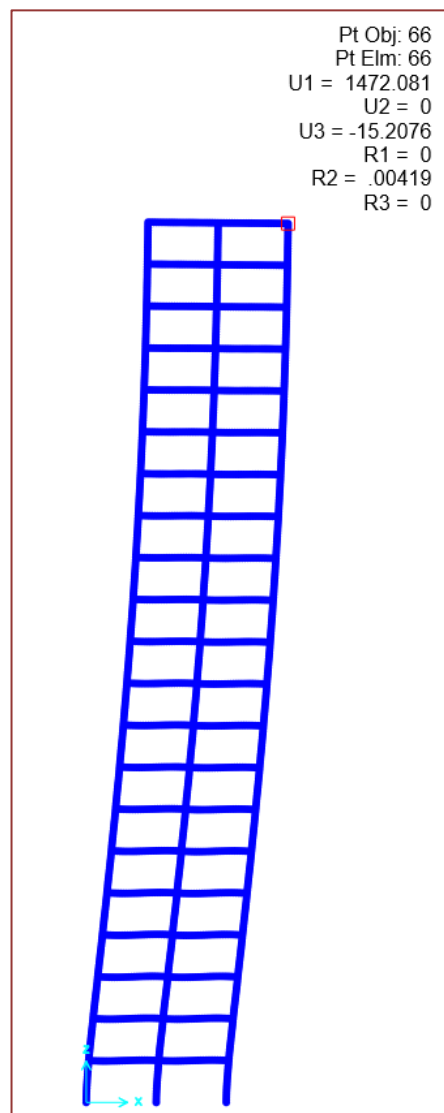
Modelo de pórtico com cargas de vento (em kN)
